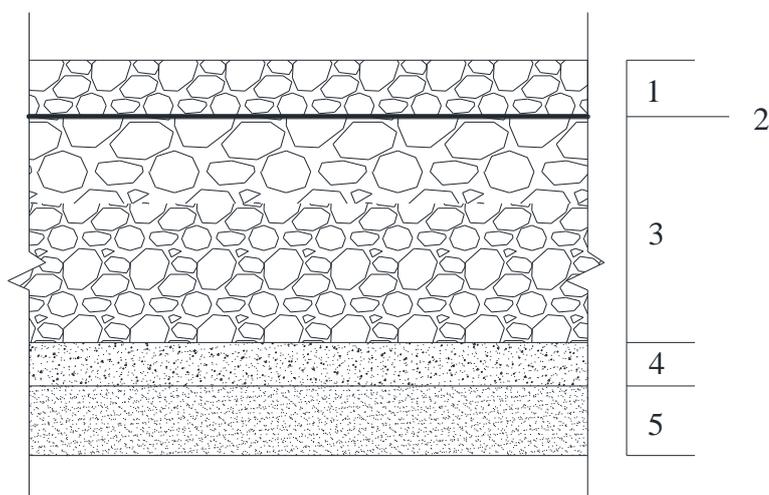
表层透水混凝土路面结构型式示意图
